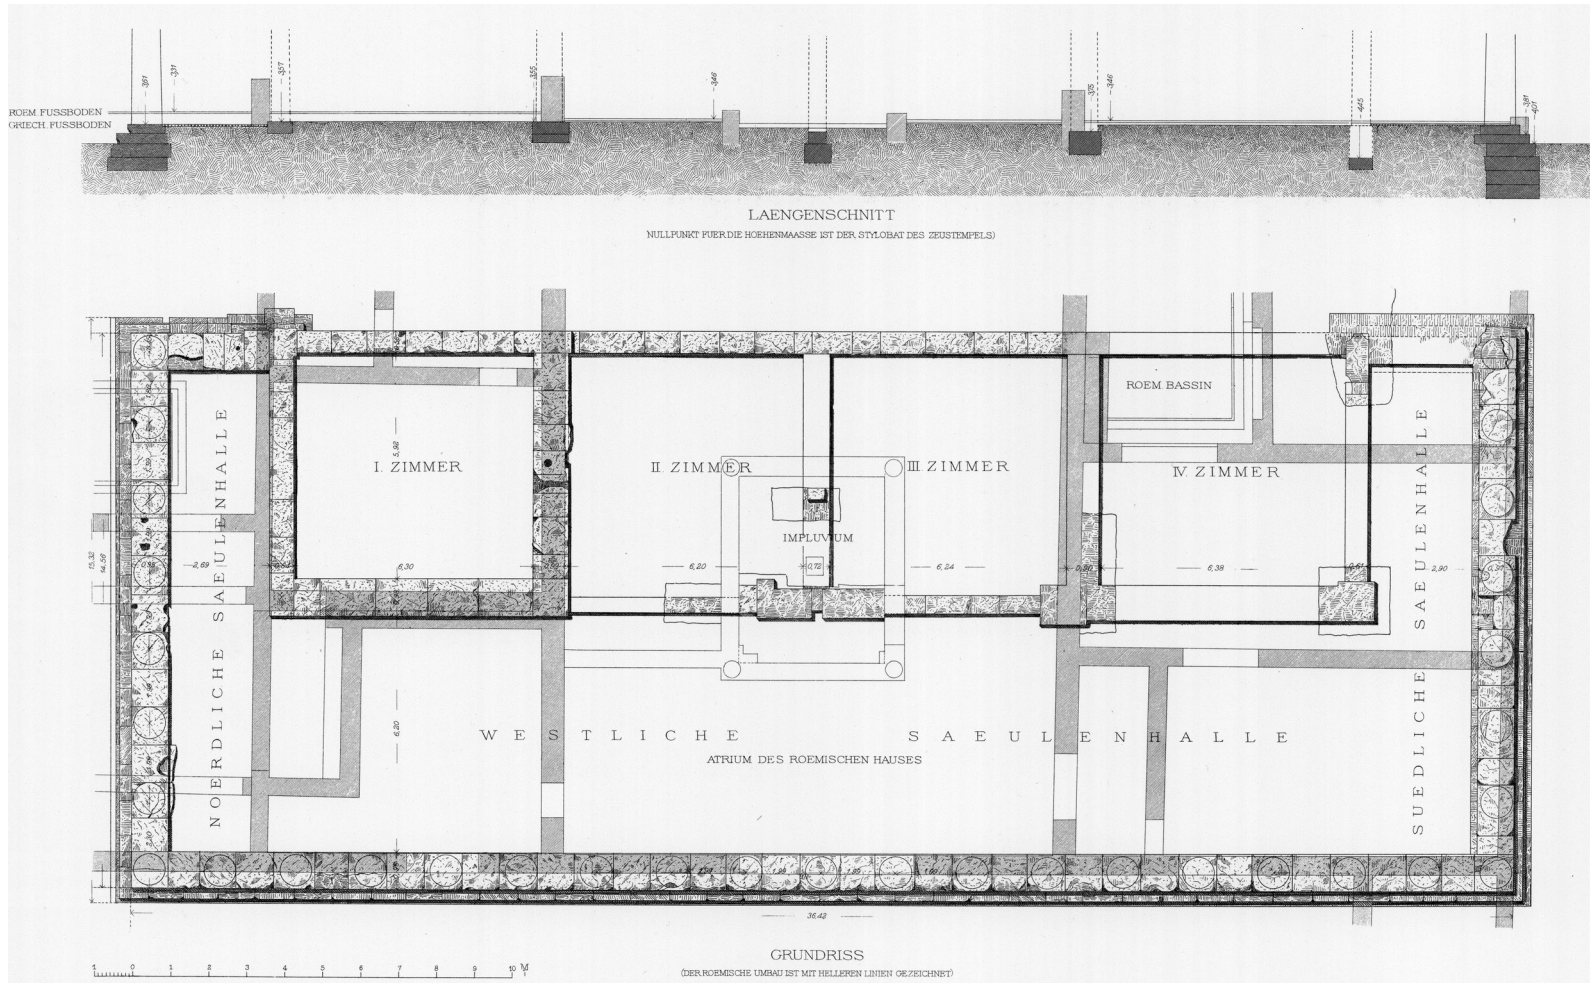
Steinplan und Längsschnitt des Südostbaus (M. 1 : 200)
